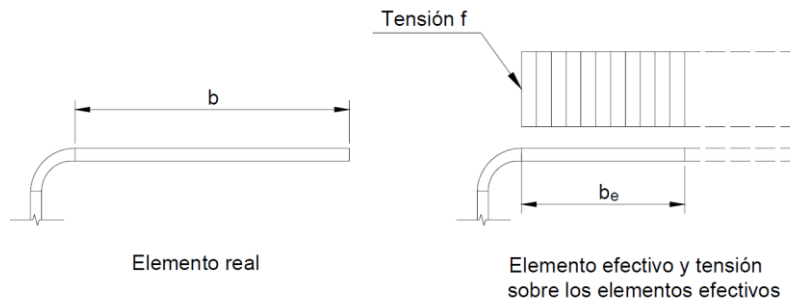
Elemento no rigidizado uniformemente comprimido (Referencia 3)
